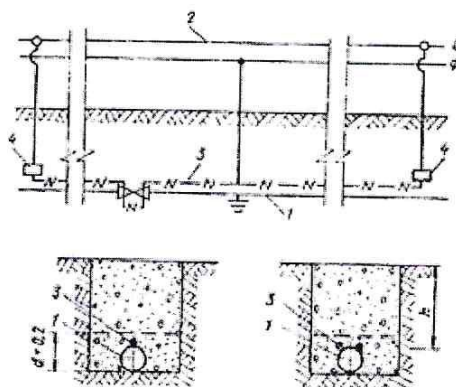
Схема оборудования водопровода греющим кабелем
